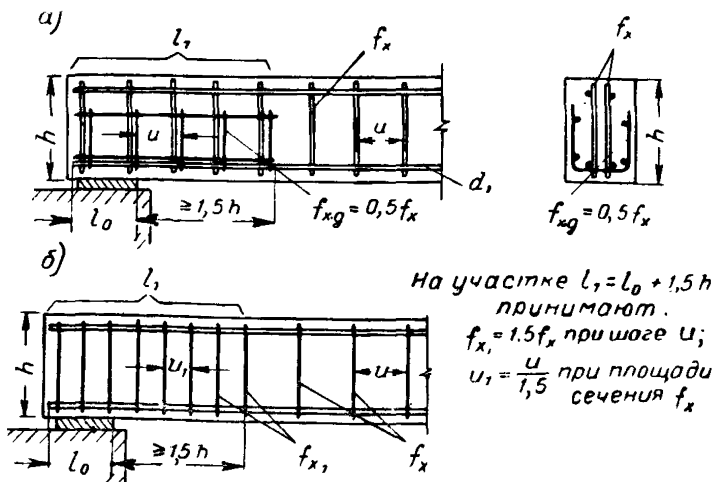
Анкеровка продольной рабочей арматуры на свободных опорах балок в случаях, когда поперечная арматура требуется по расчету, т. е. когда  $\frac{Q}{mbh_0} > R_p$ , а длина заделки стержней  $l_0$  за гранью опоры соответствует условиям:
